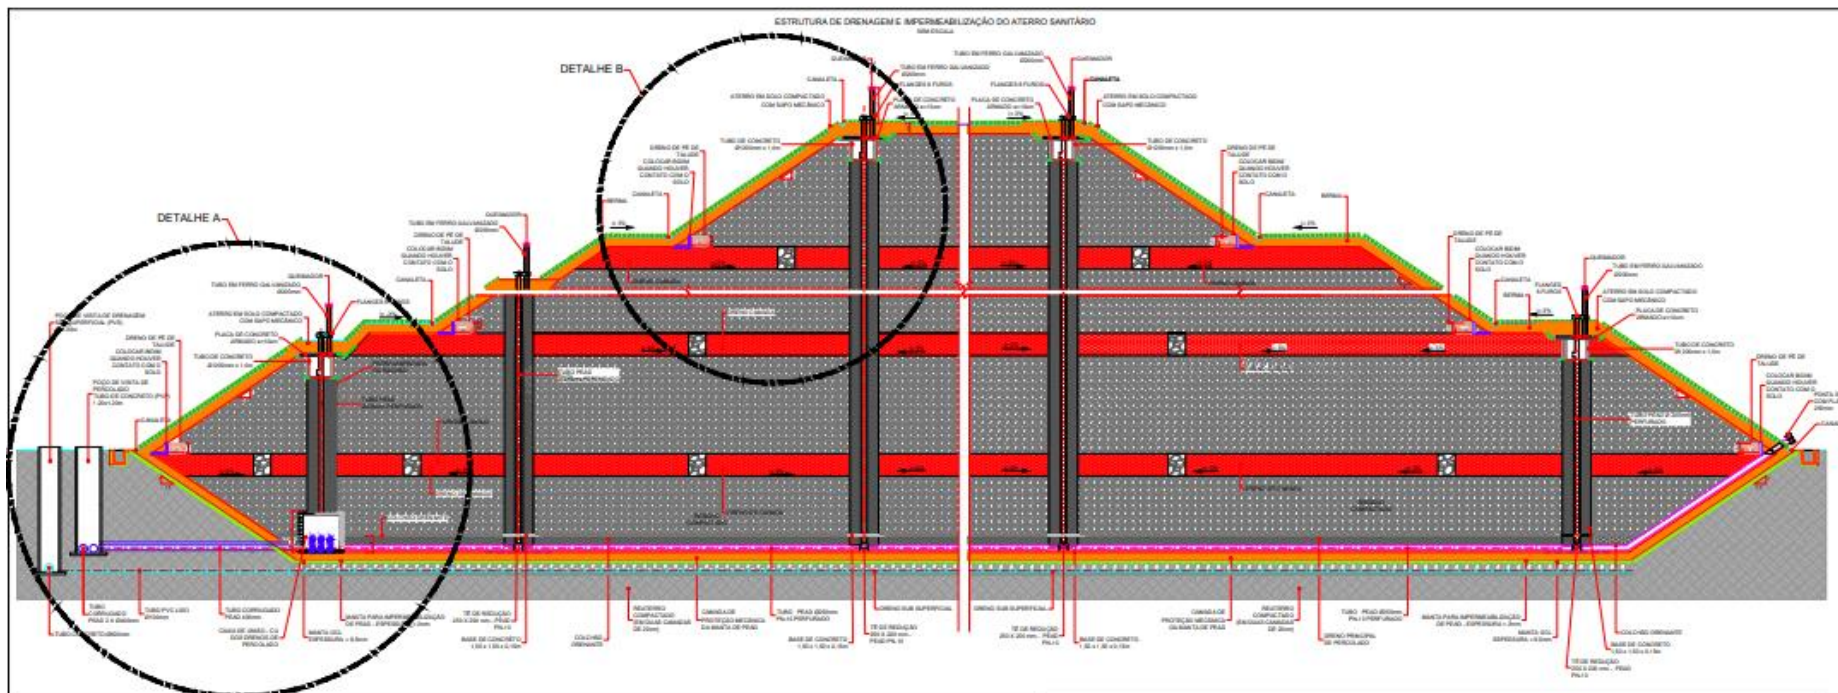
Planta do Aterro (Empresa Cepollina, 2012).
